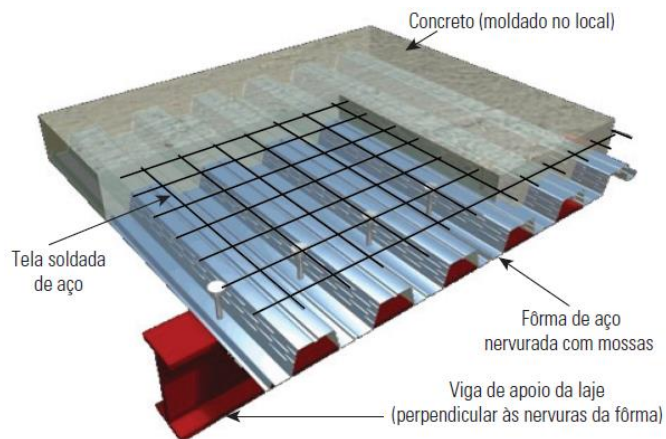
Laje mista Steel Deck (Fonte: Fakury, 2016)
